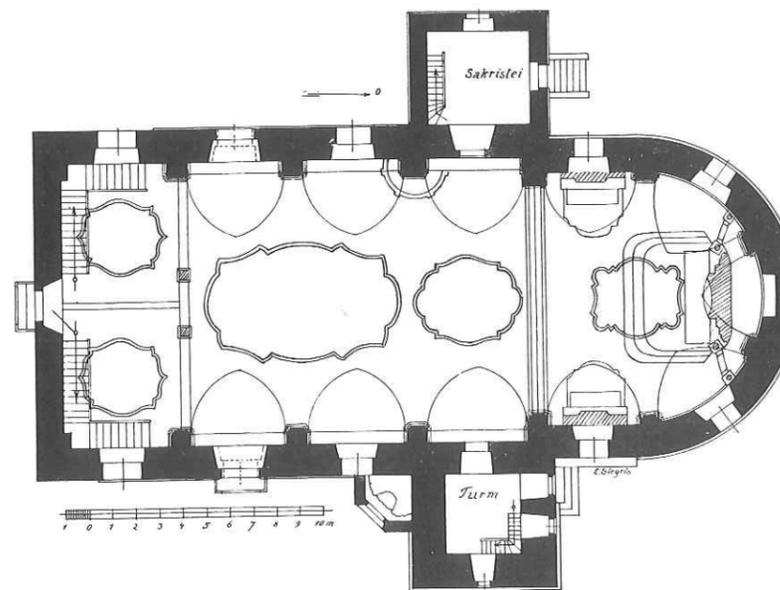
Leogang, Pfarrkirche, Grundriß (S. 118).
